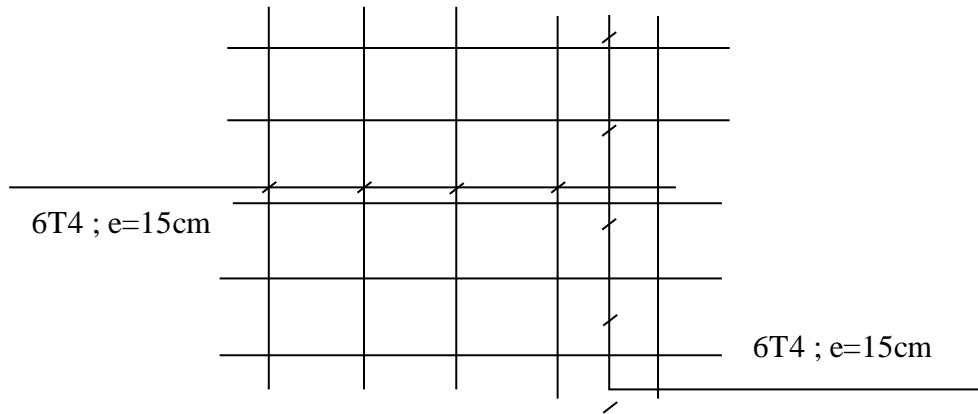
schéma de ferrailage de la dalle de compression.
